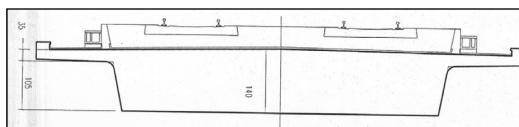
Impalcato a sezione piena in c.a.p. del viadotto Tassone. *Pre-stressed reinforced concrete full section deck of the Tassone viaduct*.
